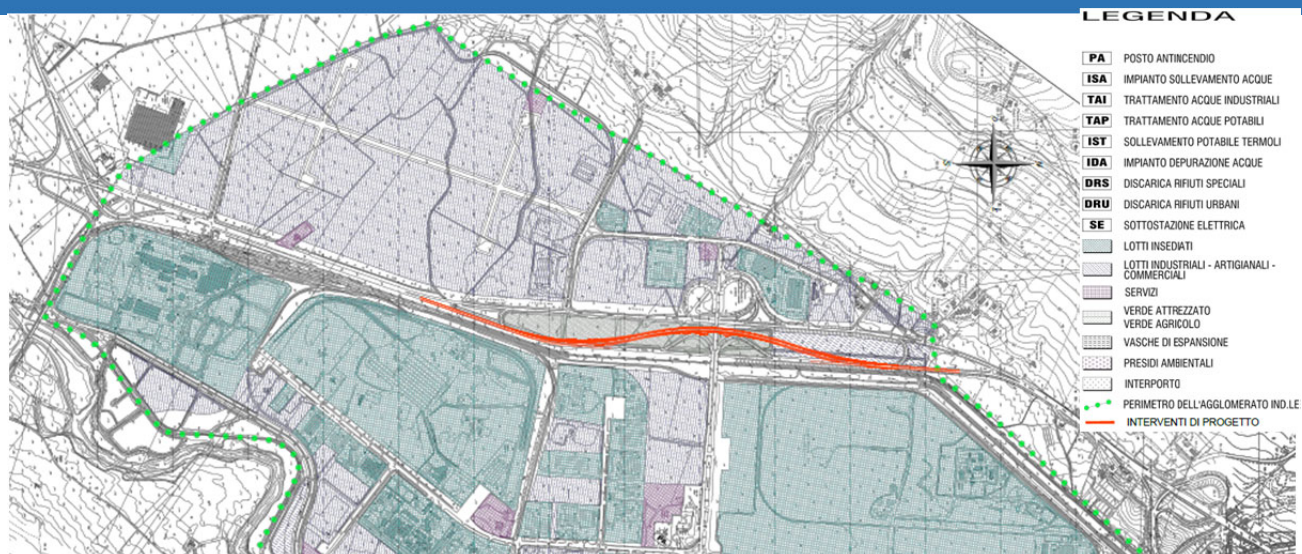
Sovrapposizione tracciato su stralcio Piano Regolatore Generale (PRG)
